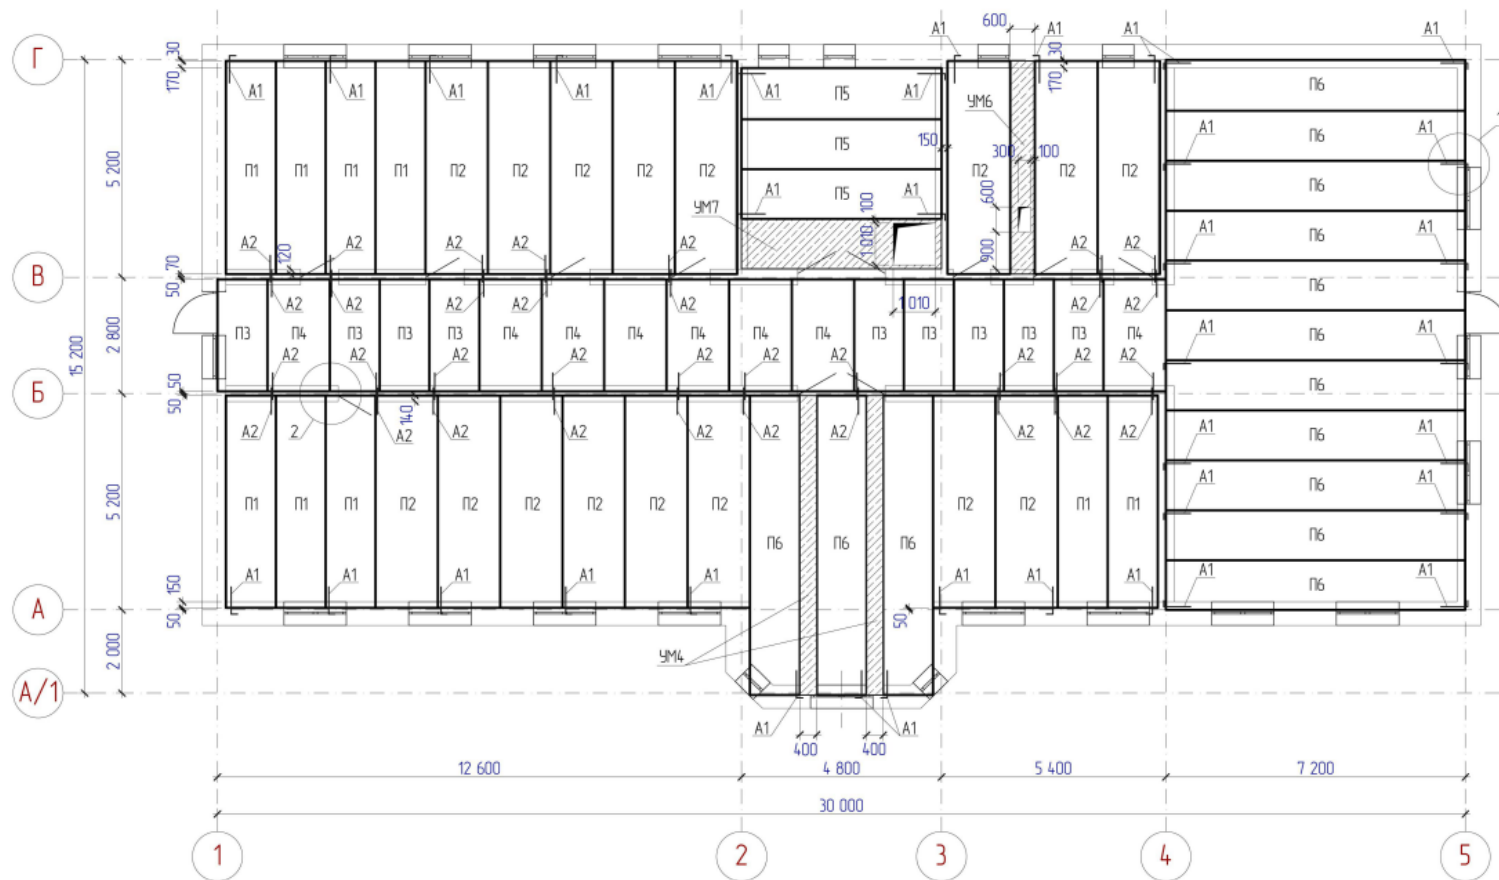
Схема расположения панелей перекрытия второго этажа
